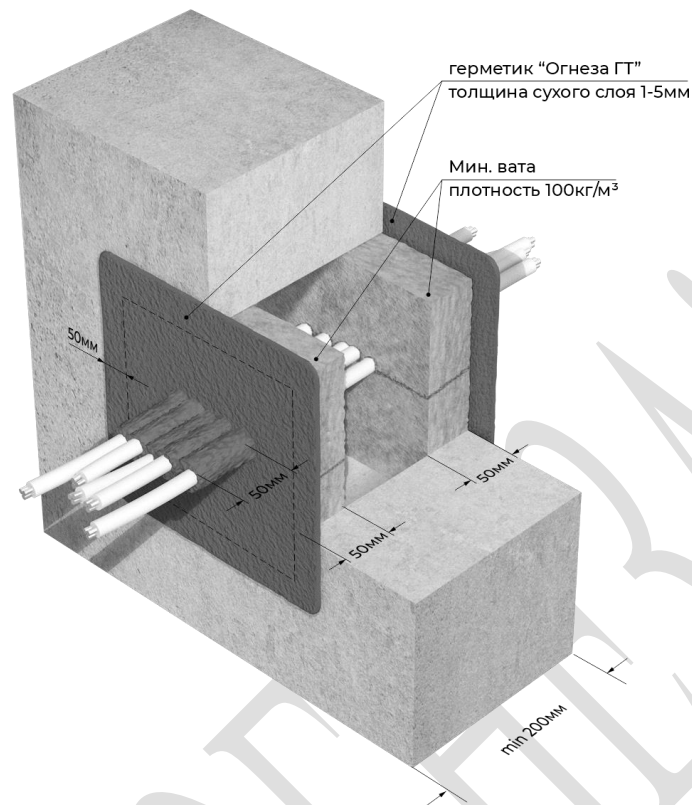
Монтаж кабельной проходки с использованием герметика «ОГНЕЗА-ГТ» для стен и перекрытий толщиной от 200 мм (ИЕТ 150)
